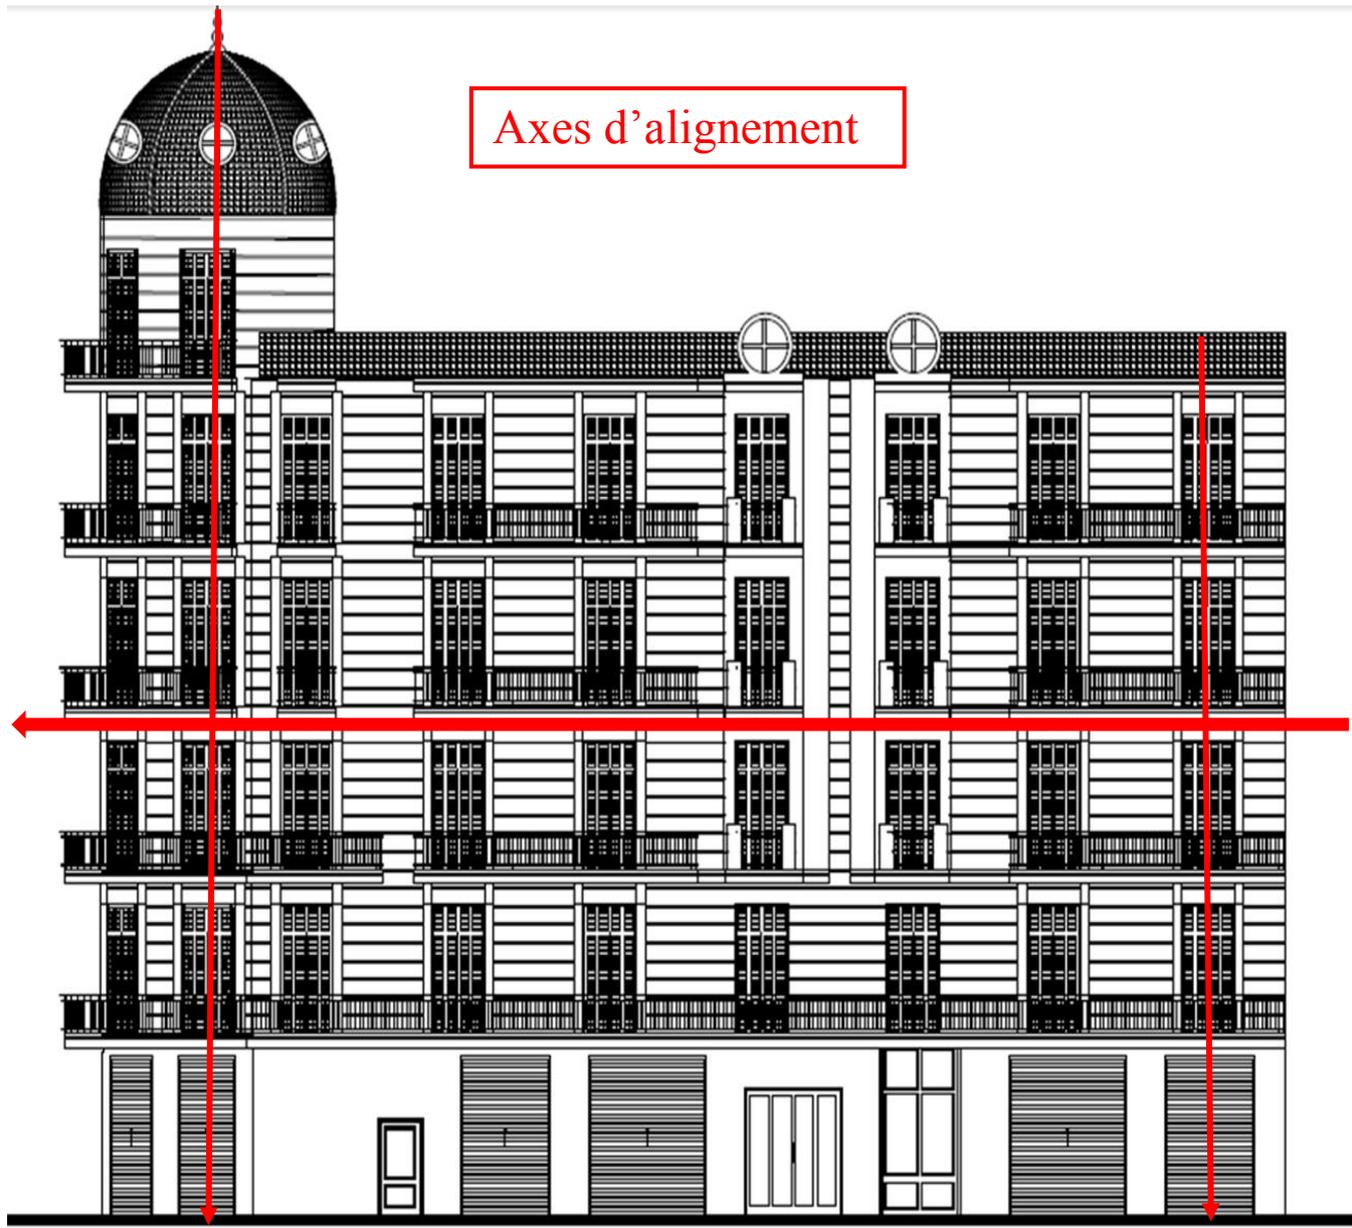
les axes d'alignement au niveau de la façade de l'immeuble Borge.
